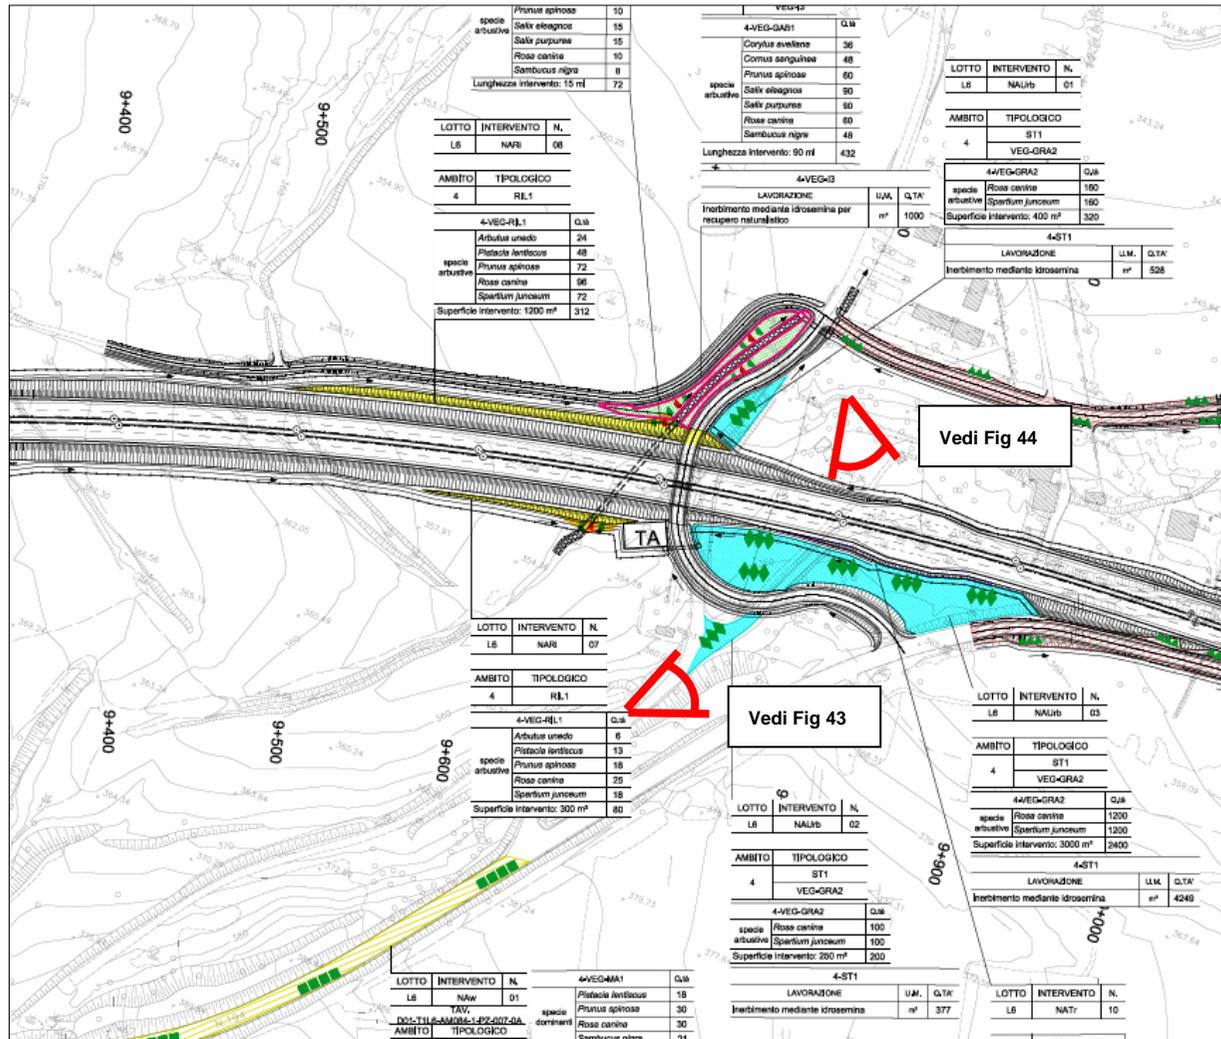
Stralcio planimetrico dell'area in progetto al km 9+900
